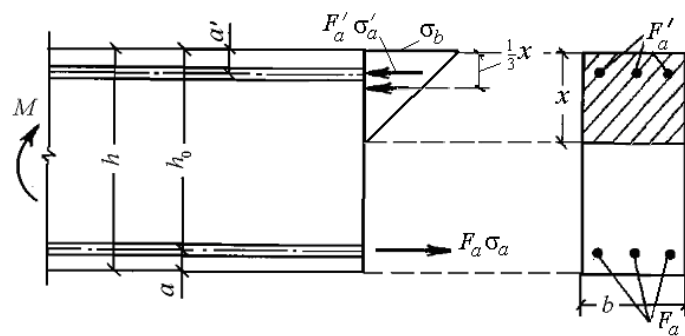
Нормальное сечение изгибаемой железобетонной балки с трещиной при двухслойном армировании
